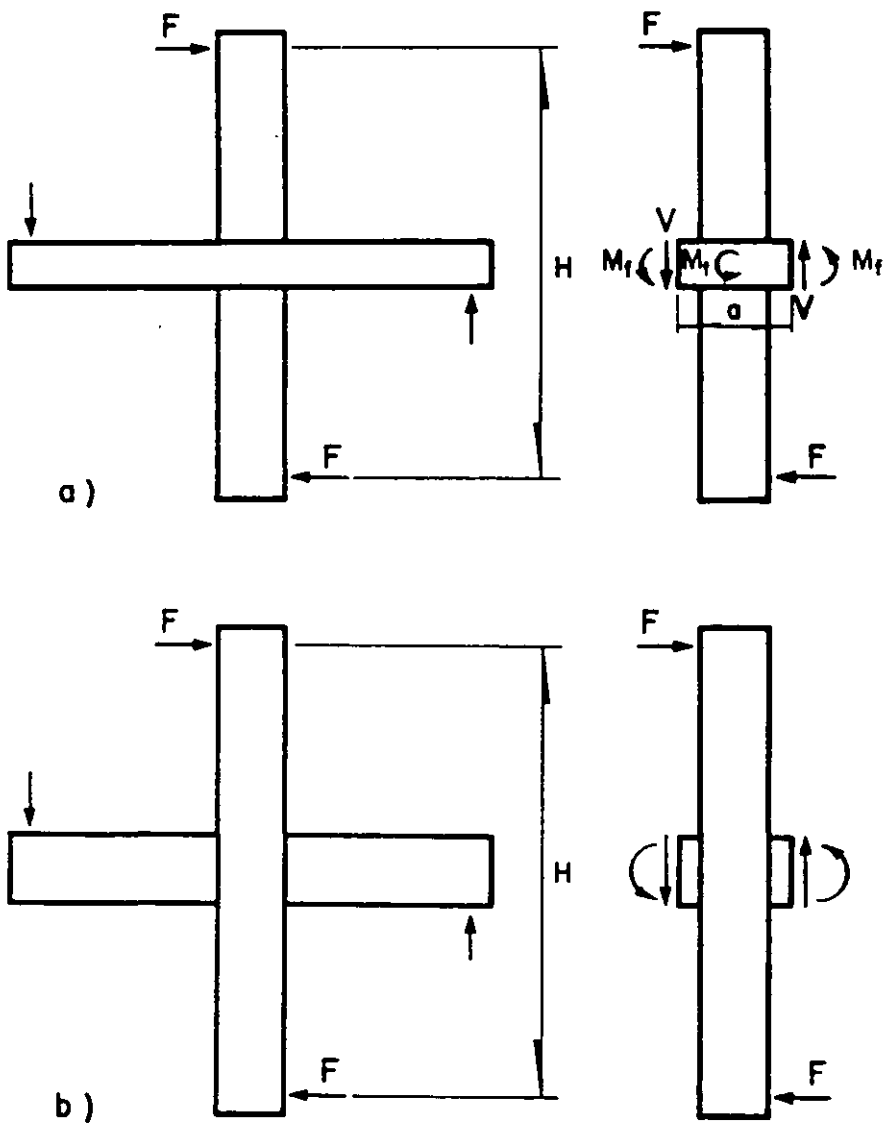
Trasmisión del momento FH entre losa y columna, y entre vigas y columna
